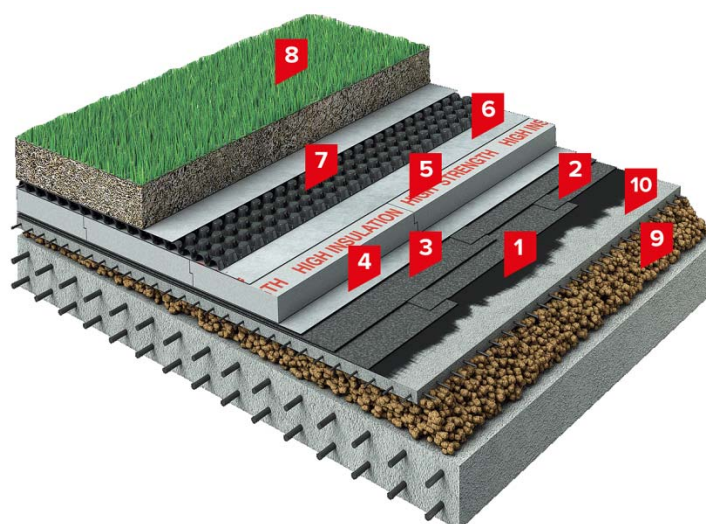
Конструкция зеленой крыши: 1 – клеевой слой; 2 – основной водоизоляционный слой; 3 – дополнительный водоизоляционный слой; 4 – нижний разделительный слой; 5 – теплоизоляция; 6 – верхний разделительный слой; 7 – дренажный слой; 8 – субстрат с зелеными насаждениями; 9 – уклонообразующий слой; 10 – армированная цементно-песчаная стяжка
